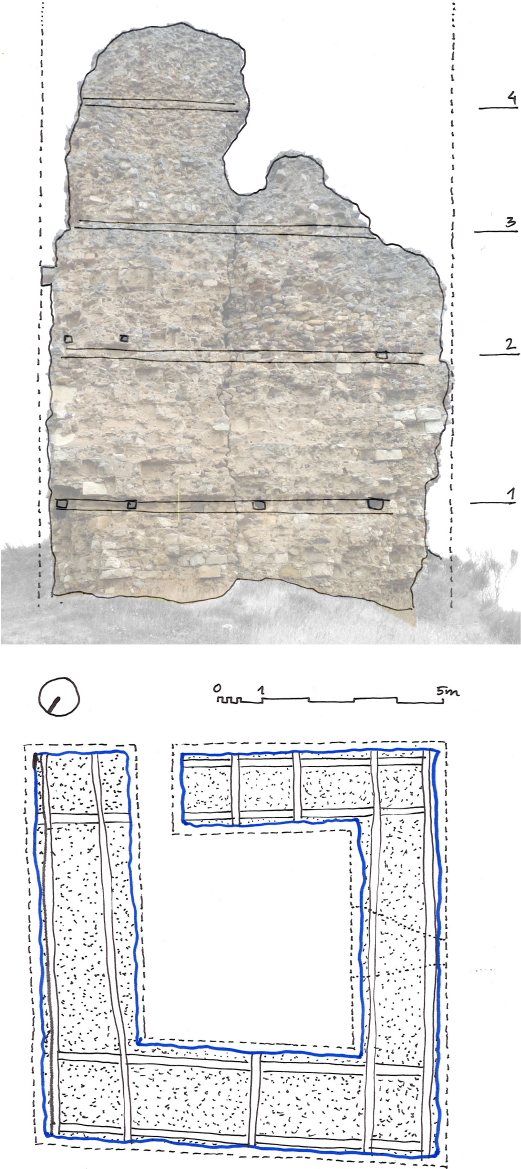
Alzado noroeste de la torre septentrional del castillo de Saldaña y planta del nivel inferior, con indicación de los marcos de refuerzo visibles en las huellas dejadas en los muros y tras el espolio de la sillería de los paramentos (fuente: autor)
